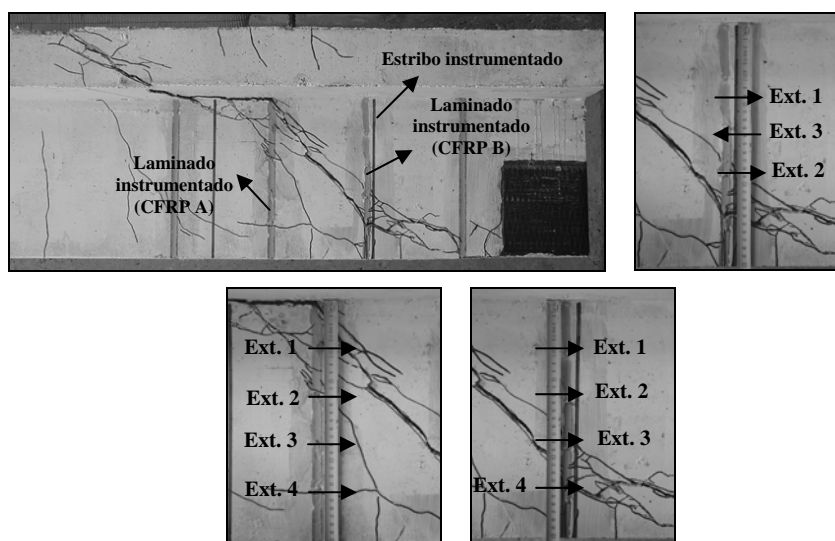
Localização dos extensómetros no laminado e estribo instrumentados da viga 2S-4LV-B.
